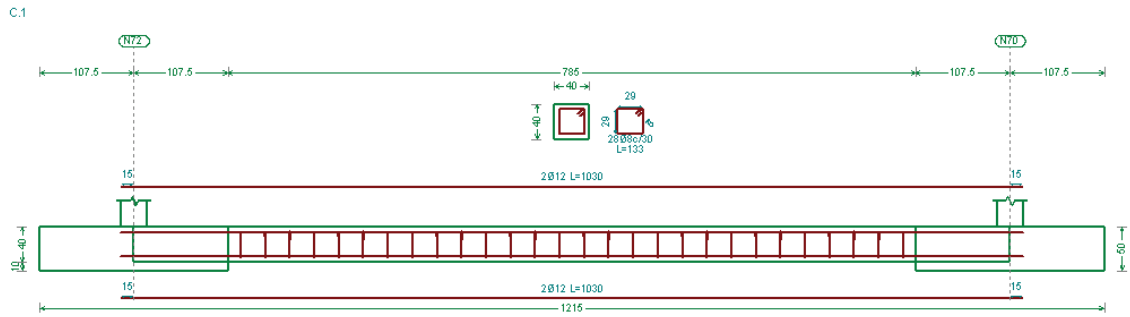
Armado viga riostra zapata pilarillo-zapata pilarillo
